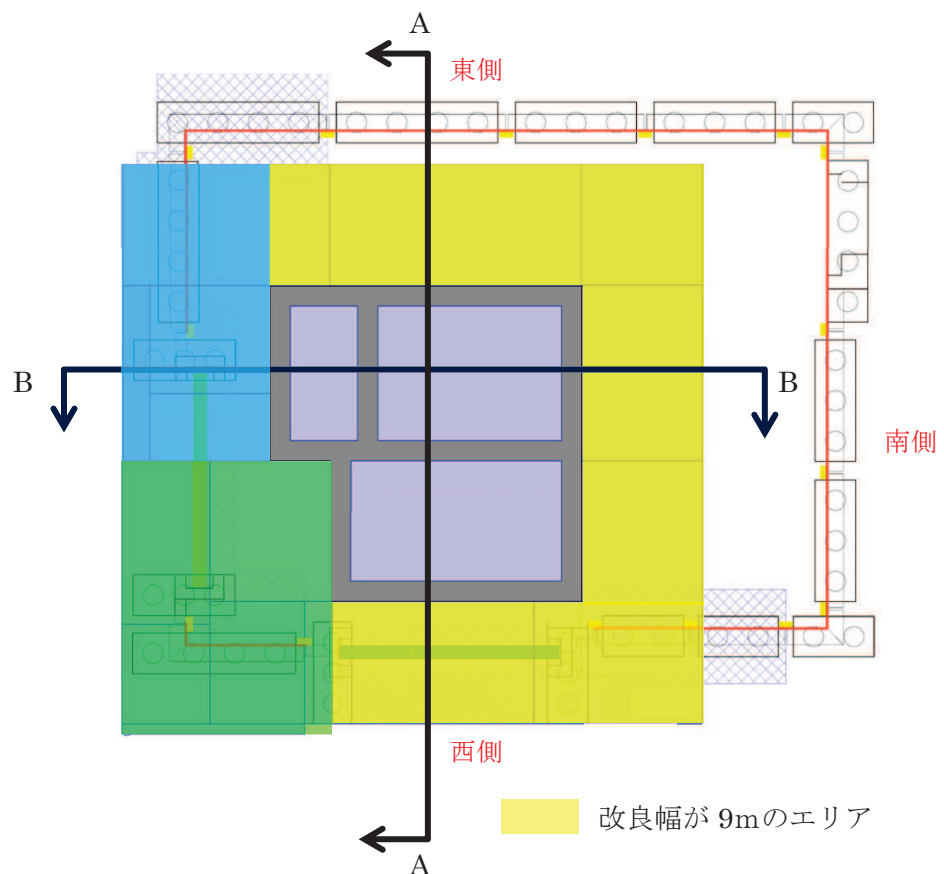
第 3 号機放水立坑評価対象断面 平面図
